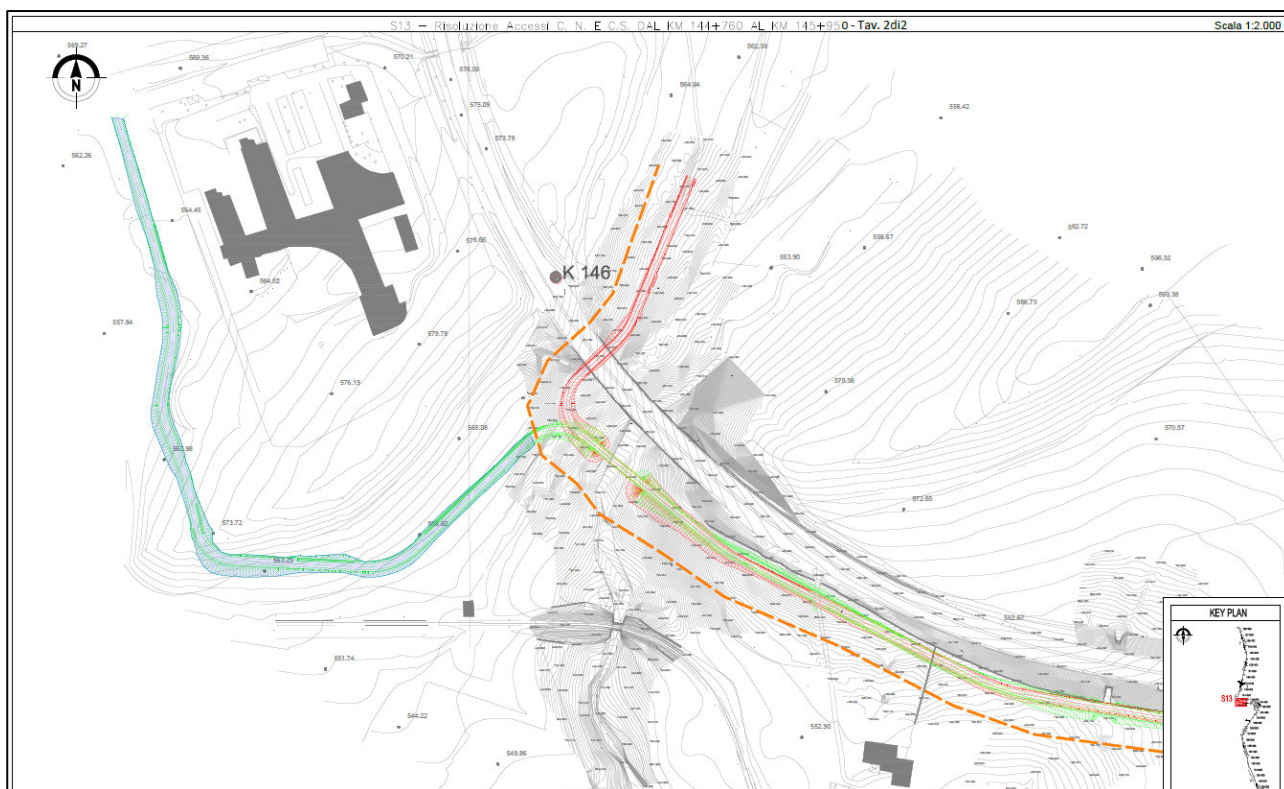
stralcio planimetrico modifica progettuale intervento S13 al di fuori delle fasce di rispetto
